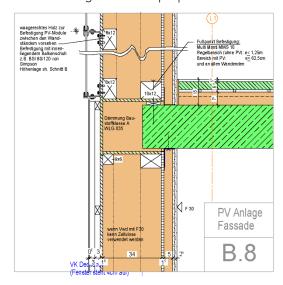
Detail nichttragende Außenwand mit Fassaden-PV [Architekt Wamsler].
